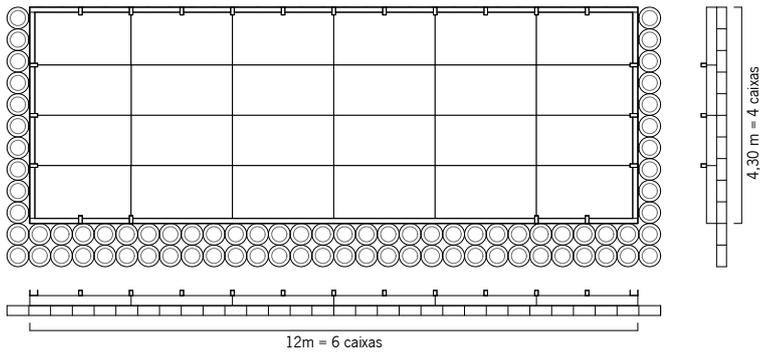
Planta e alçado lateral do posicionamento das caixas - 1/150
